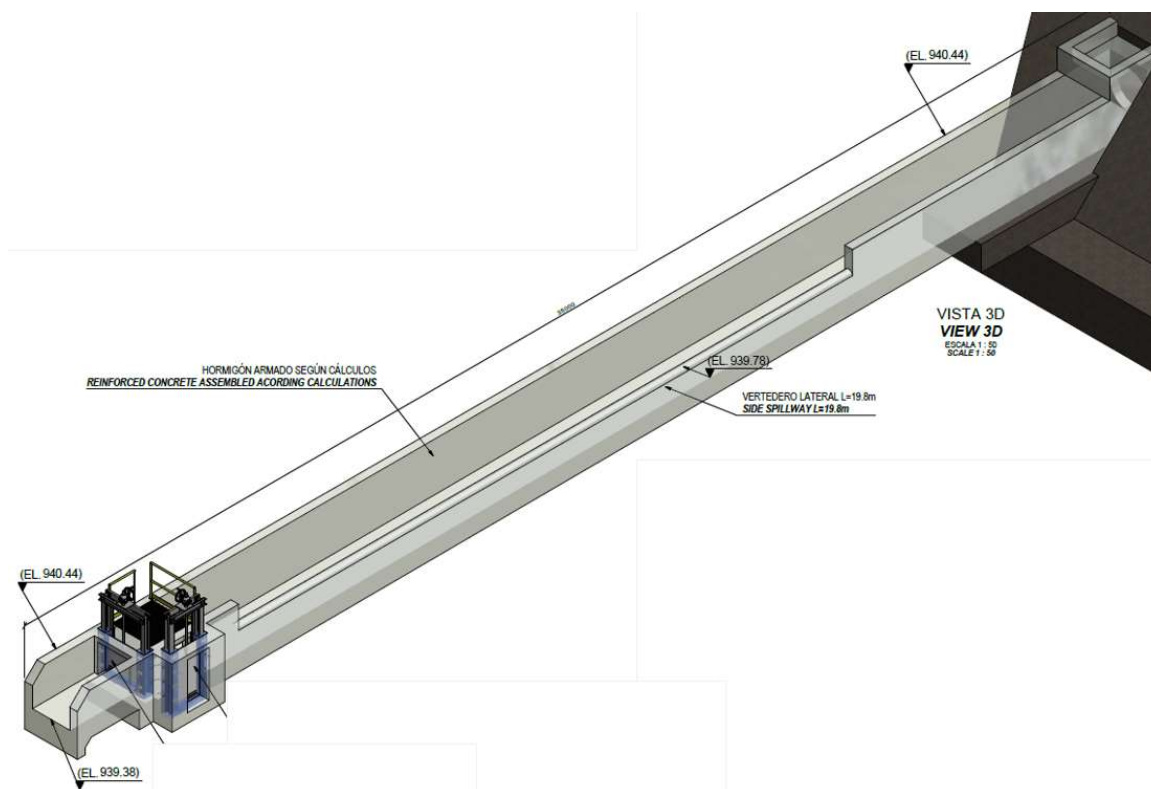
Vista 3D del canal de empalme y vertedero lateral
